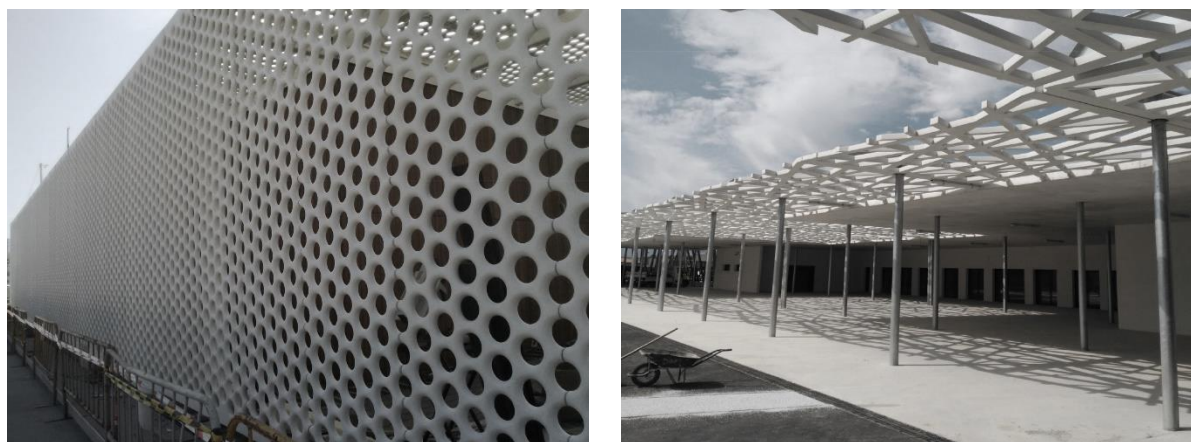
Ejemplos fachadas de hormigón arquitectónico autocompactante (material proporcionado por MC Spain)
